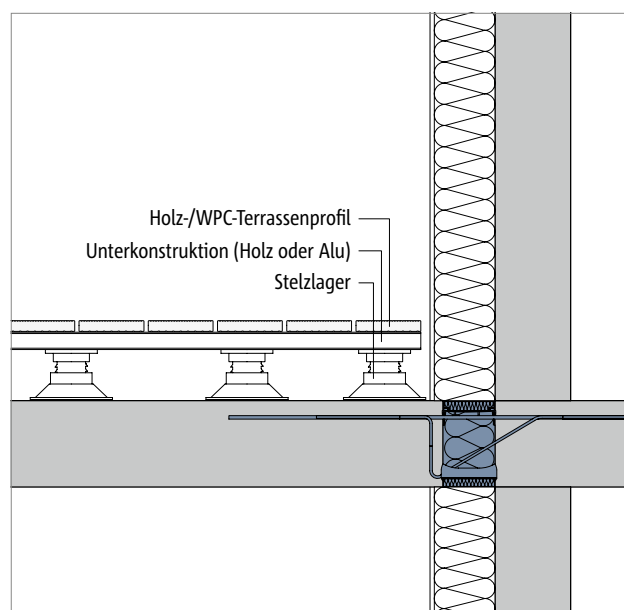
Balkonbelag mit Holz-/WPC-Terrassenprofilen, Unterkonstruktion (Holz oder Alu) und Stelzlager
